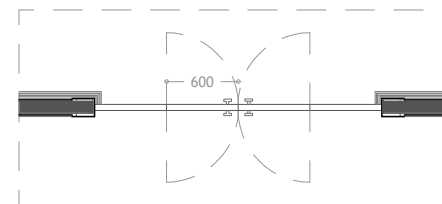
Levantamento gráfico da Porta P5 - Planta - Escala 1:50
